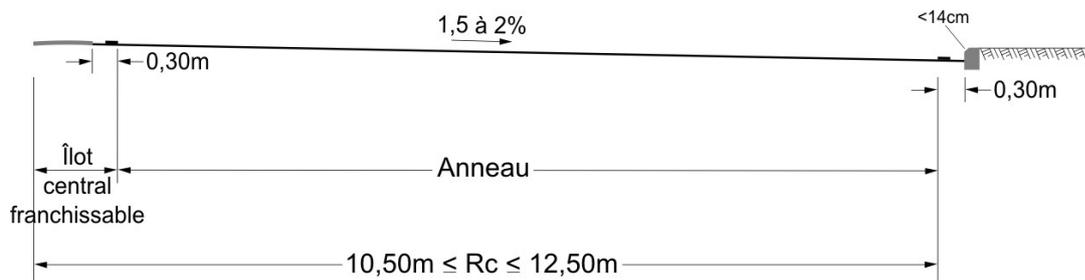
Profil en travers type de l'anneau du giratoire sans surlargeur
